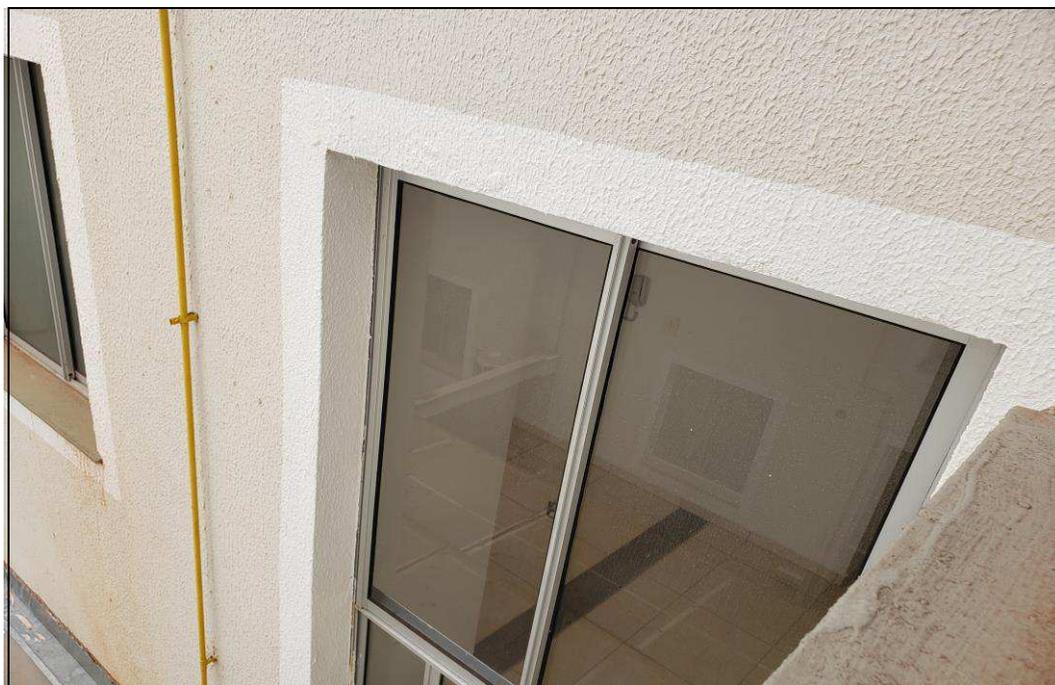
Vista geral externa do apartamento, onde também observamos o interior do mesmo.
